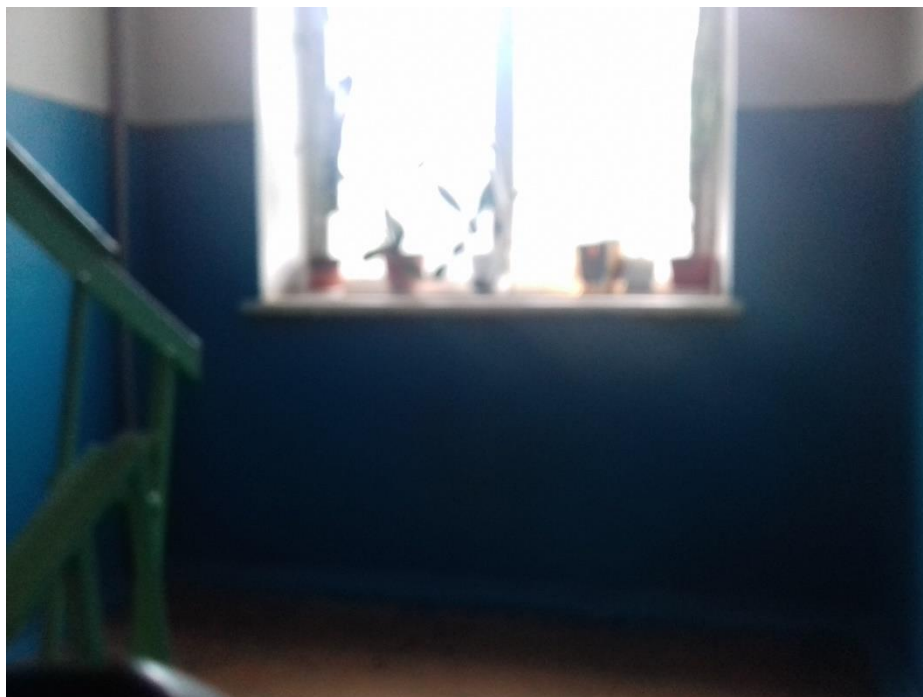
Общий вид лестничной площадки между вторым и третьи этажом.
